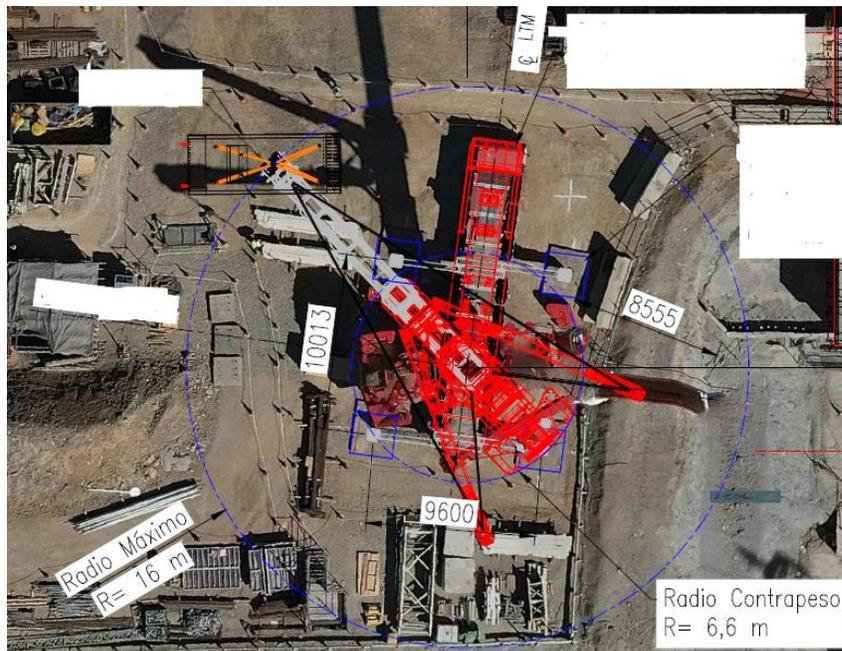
Ejemplo de vista en planta con gálbo de la maniobra.
